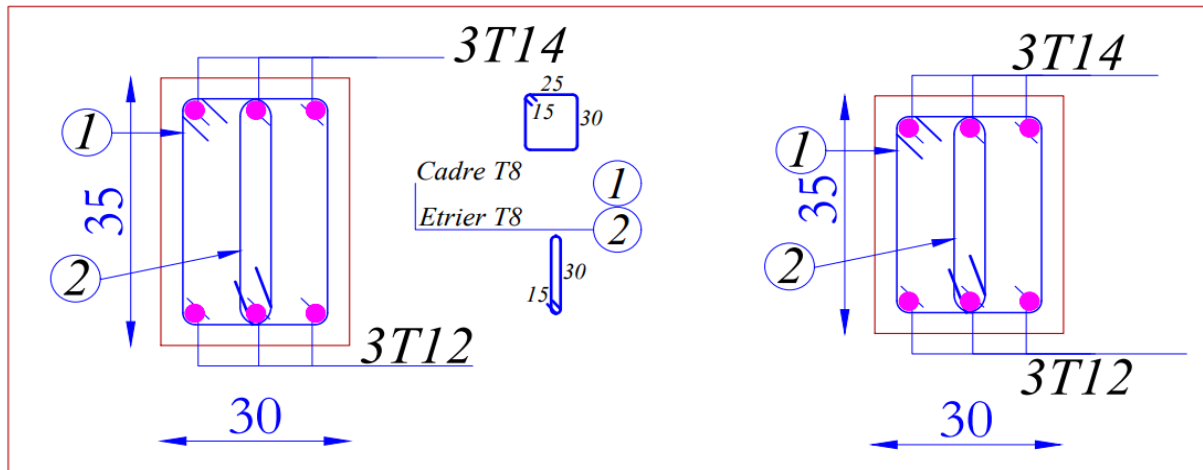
schéma de ferrailage des poutres secondaires non associées au voile.
